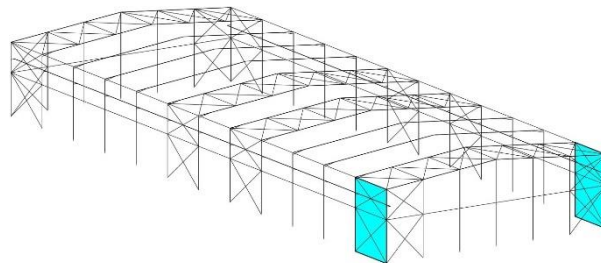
Arriostamiento de fachada lateral. Fuente: Elaboración propia
